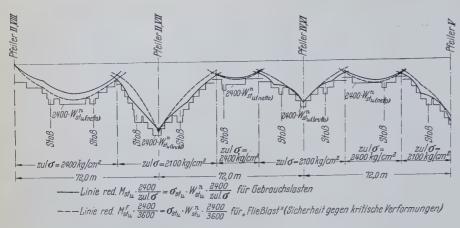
Abstufung der Untergurtlamellen einschließlich Stoßdeckung
